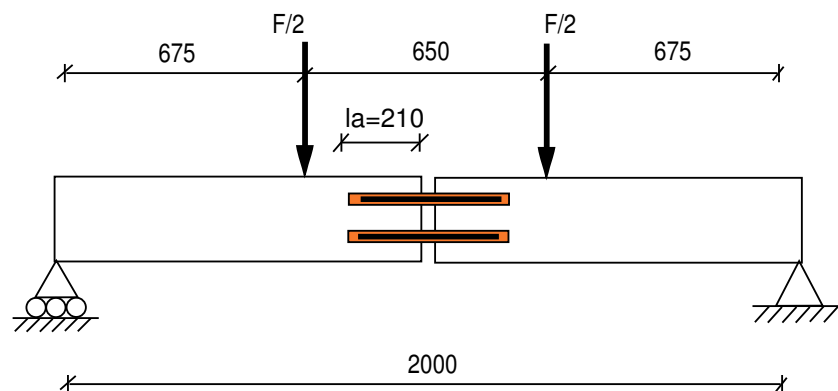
Géométrie de l'éprouvette de flexion
